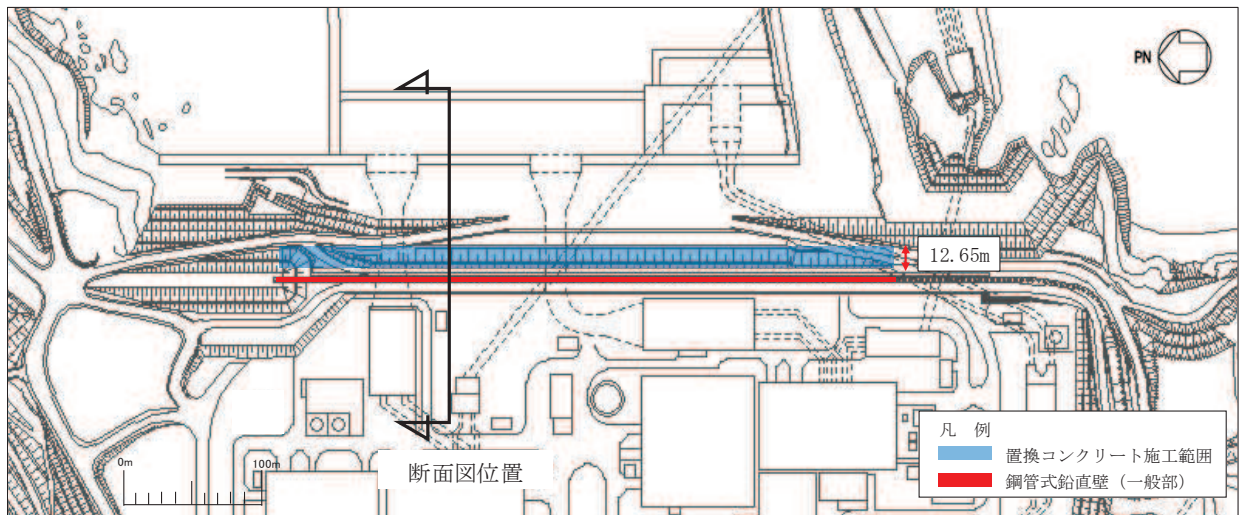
(1) 置換コンクリートの施工範囲（平面図）
